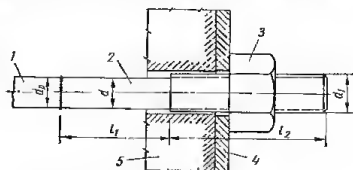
Анкер для стержневой арматуры: 1 — арматурный стержень; 2 — концевой элемент с резьбой; 3 — гайка; 4 — распределительный лист; 5 — конструкция.
